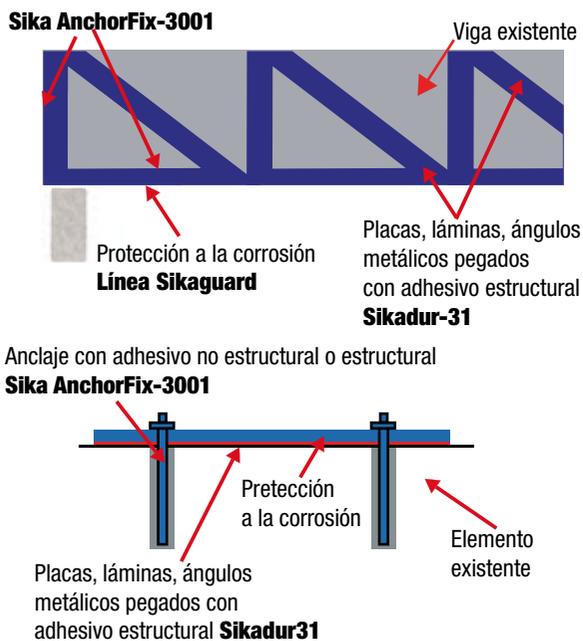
Reforzamiento con placas, láminas, ángulos de acero
